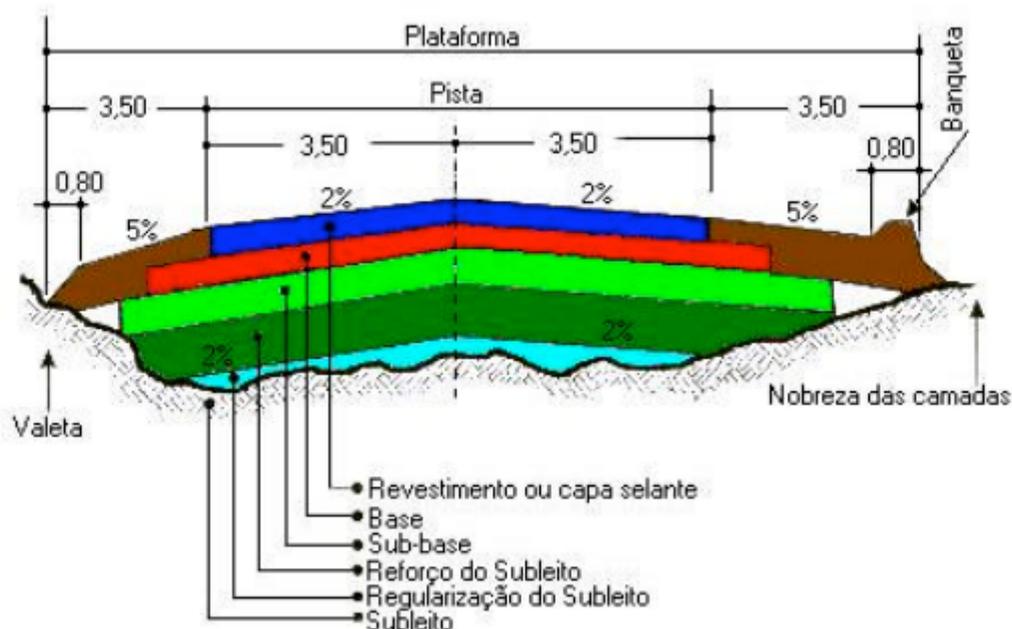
Seção Transversal Típica de Pavimento Flexível (MARQUES)
